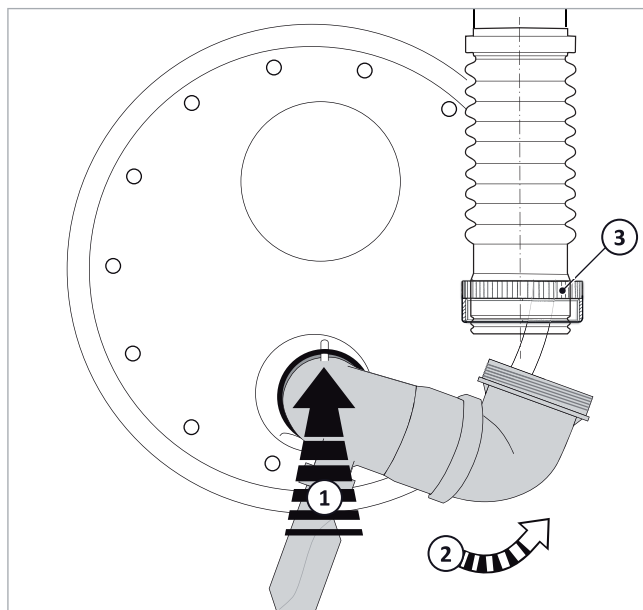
Rookgasaansluitleidingstuk recht uitlijnen
